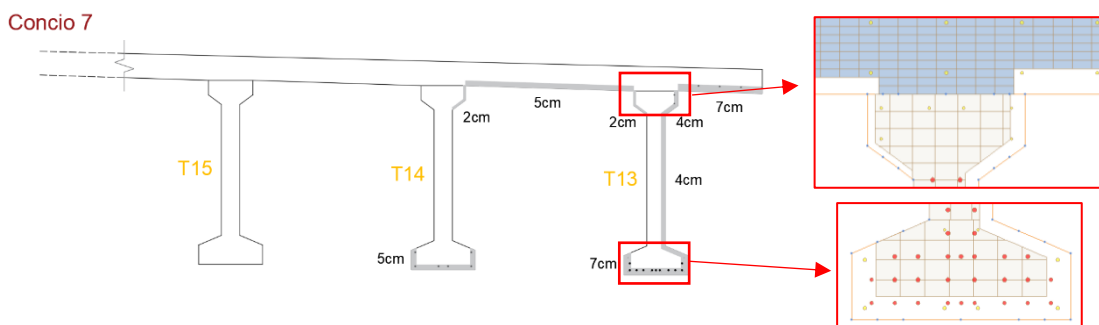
Ponte sul torrente Mavigliano, Caso I_ev4 sezione trasversale Concio 7 + dettagli Midas Civil
